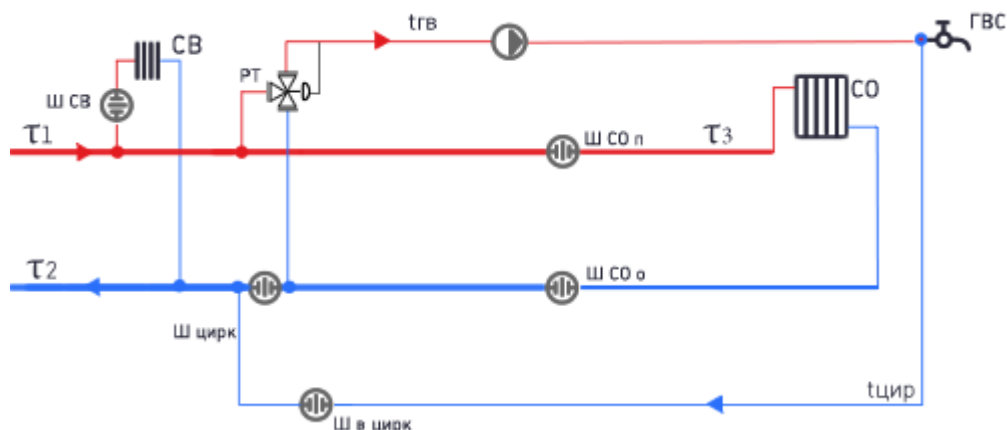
Непосредственное присоединение системы отопления к тепловым сетям с открытой схемой ГВС
